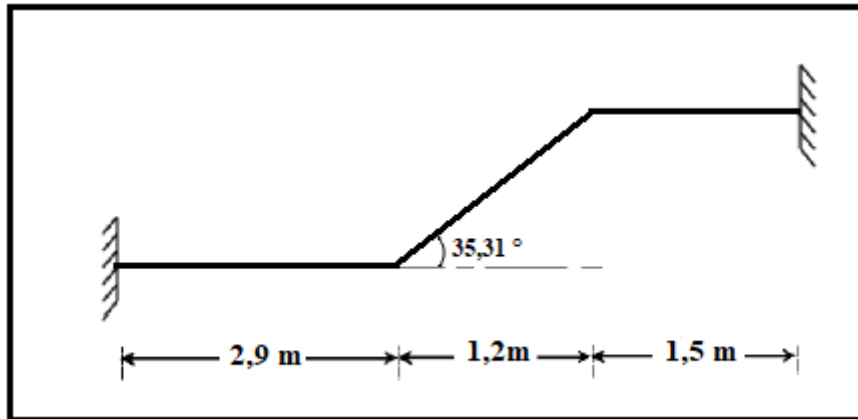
Schéma statique de la poutre brisée du 1^{er} étage
